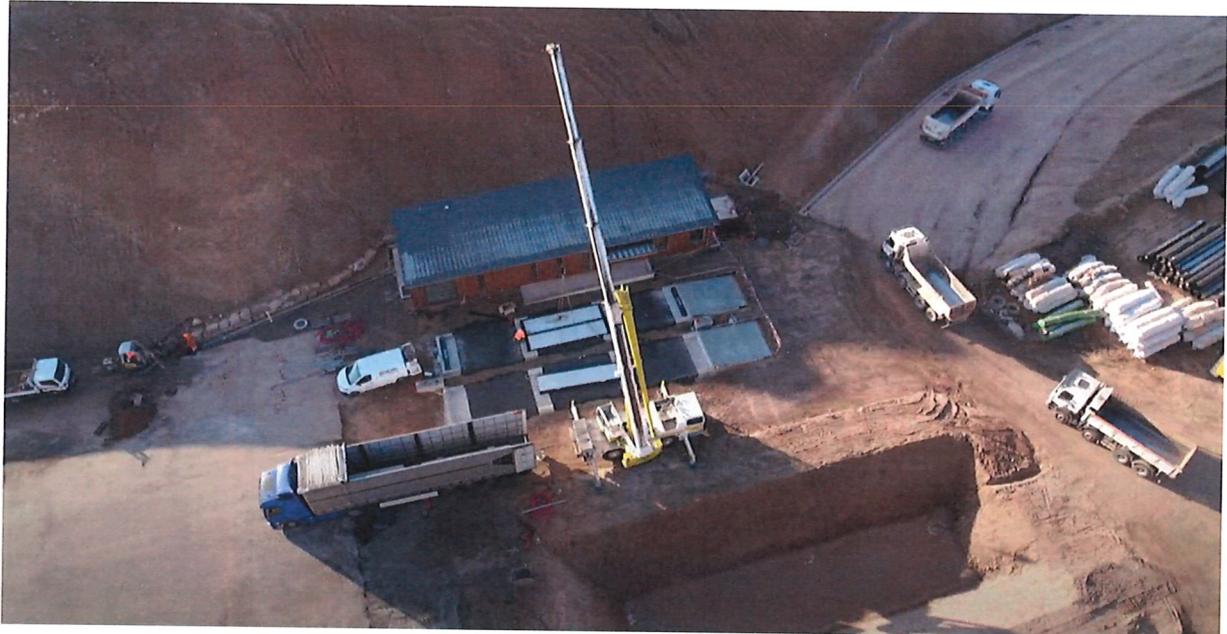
Création d'un plancher béton avec ossature bois pour l'enveloppe
